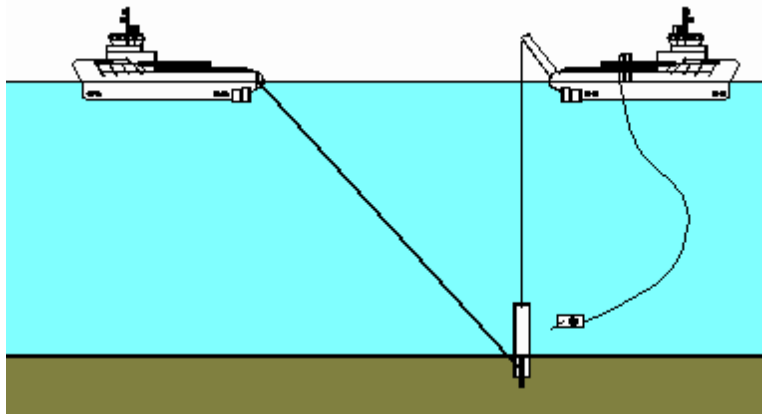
SEPLA (Suction Embedded Plate Anchor)
